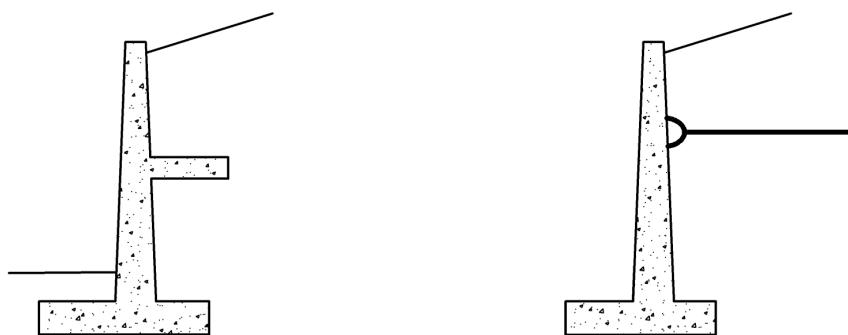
Exemples de murs en béton armé coulés en place ou préfabriqués
